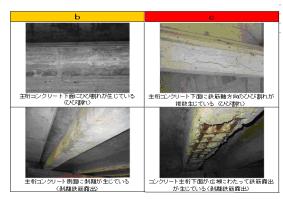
ひび割れと剥離鉄筋露出の判定例
